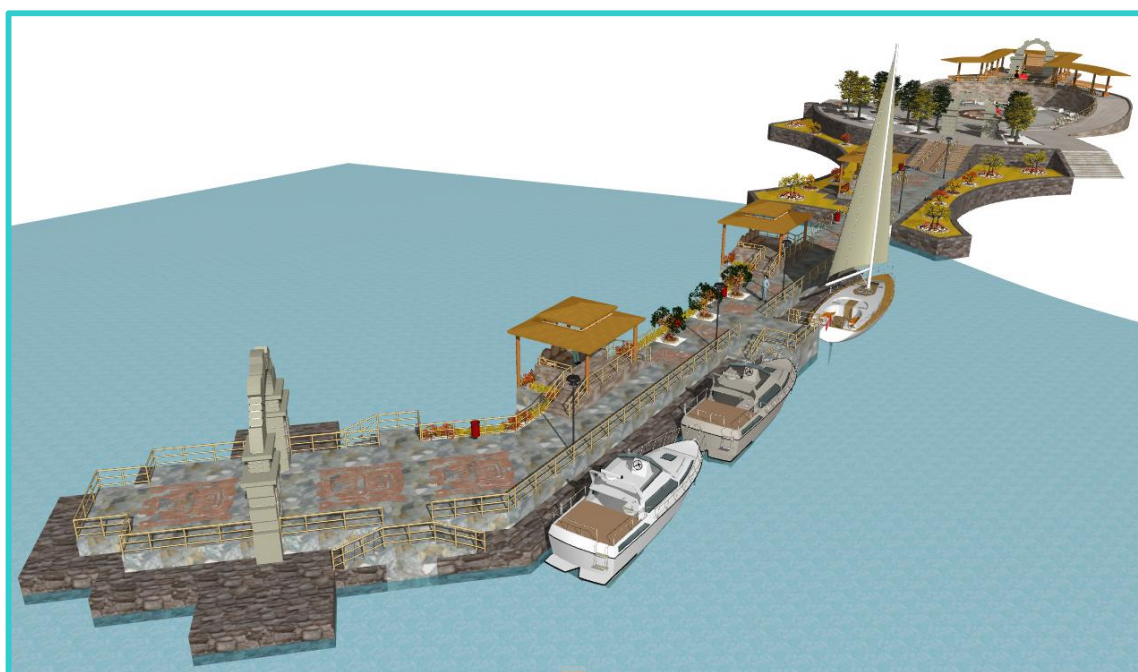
Vista Este Embarcadero, Plaza Secundaria y Playas
